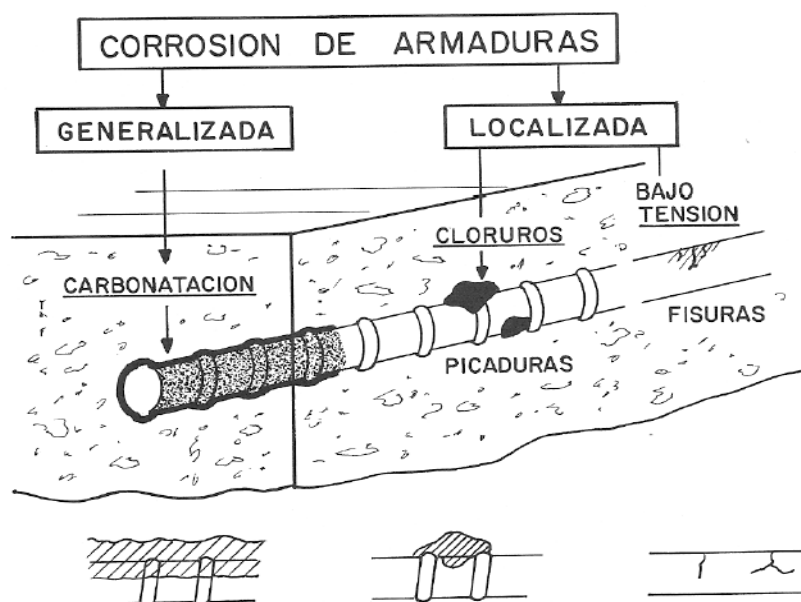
Tipos de corrosión de armaduras [5]
